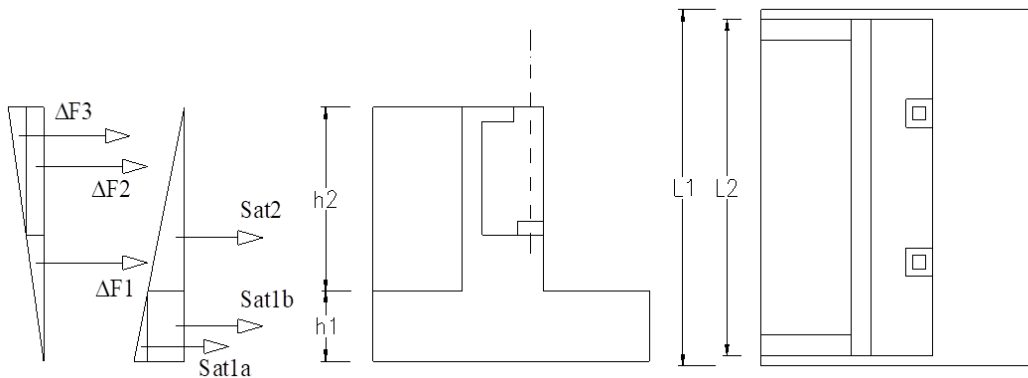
SCHEMA AZIONI ORIZZONTALI SPALLA – RINTERRO
